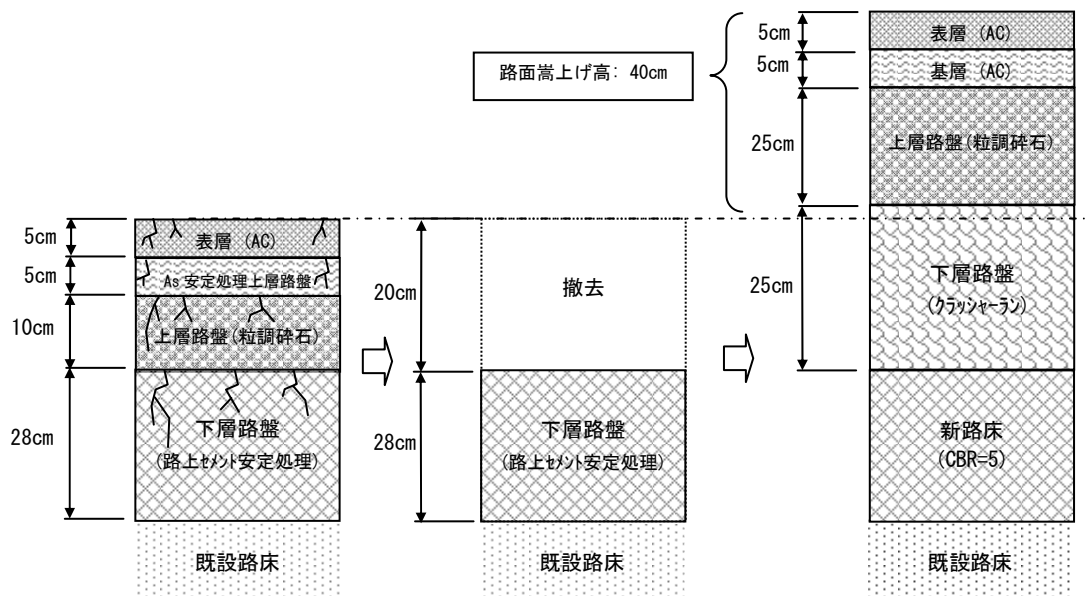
改修区間-2 地方部舗装打換工事の構造図（ひび割れ率+補修率>15%、新たな路盤材料）
